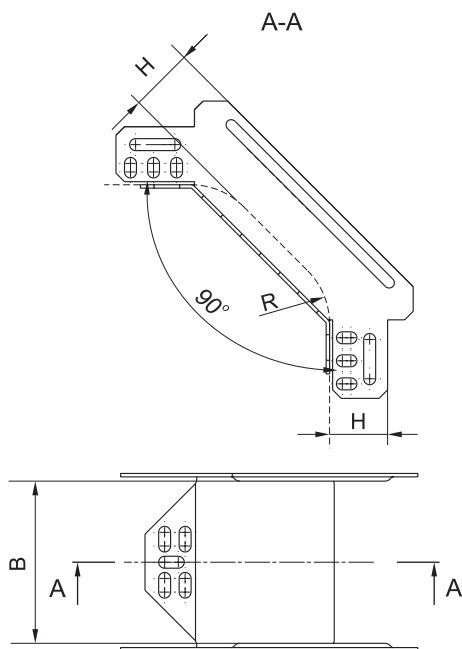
Поворот 90° вертикальный внешний. Размеры для размещения кабеля /
